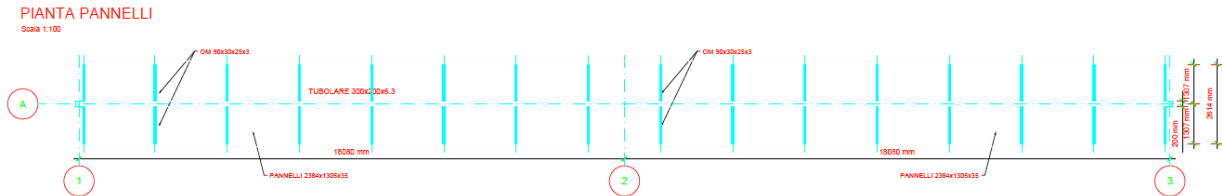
Vista in pianta della struttura "Tracker bassa (Tracker T04)"
